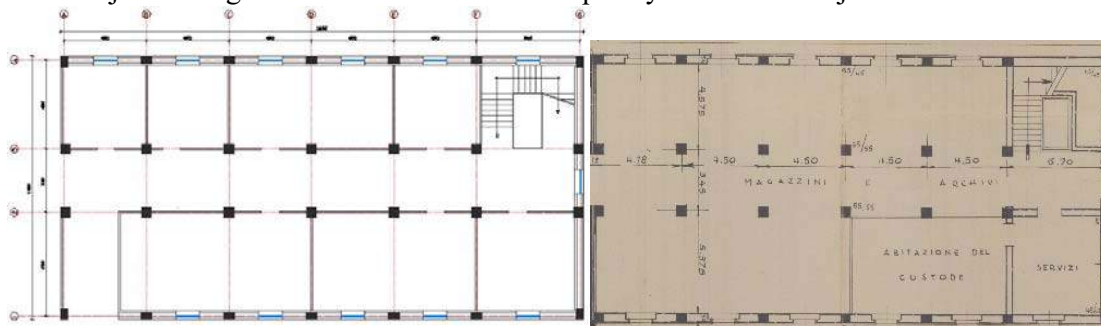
Planimetria e podrumit: Majtas planimetria e sotme, Djathtas planimetria nga projekti original
